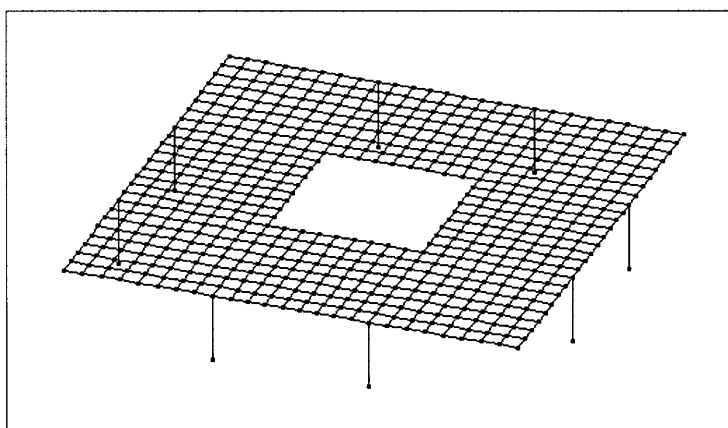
Modelo correspondiente a una planta de los edificios anexos.
